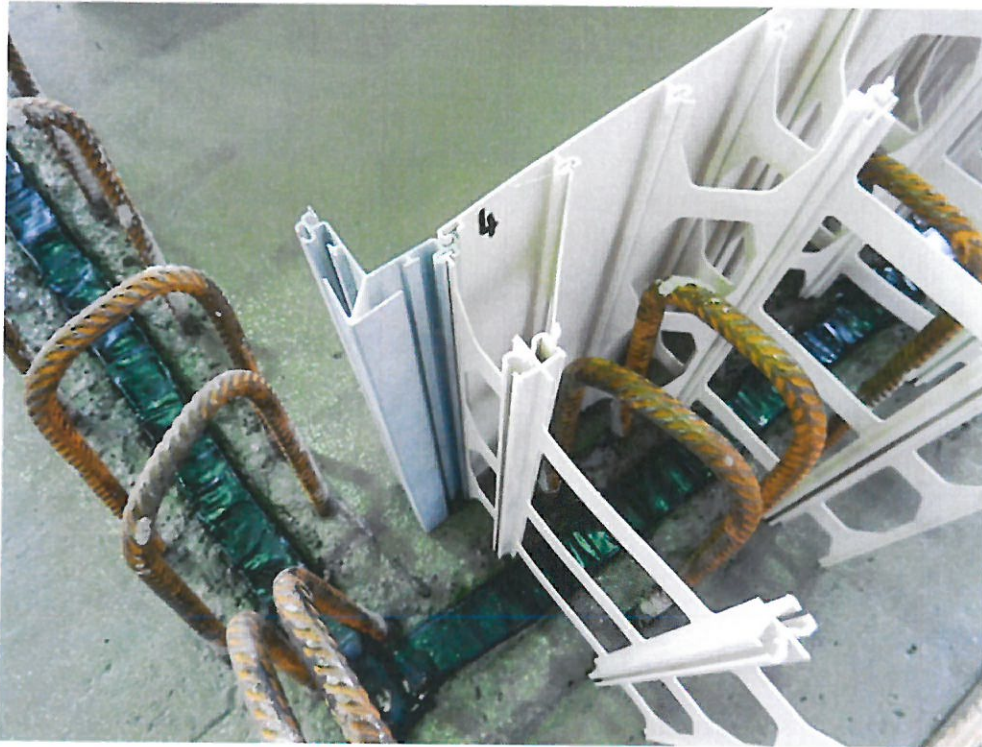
Detailansicht Eckelement (Sonderteil als 3D-Druck)
